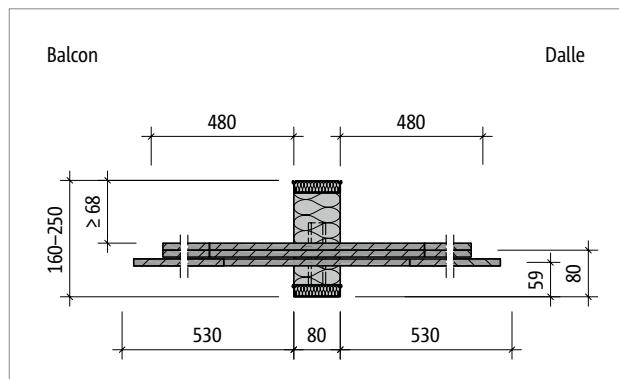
Schöck Isokorb® T Type H-VV2-NN1 : Coupe du produit
